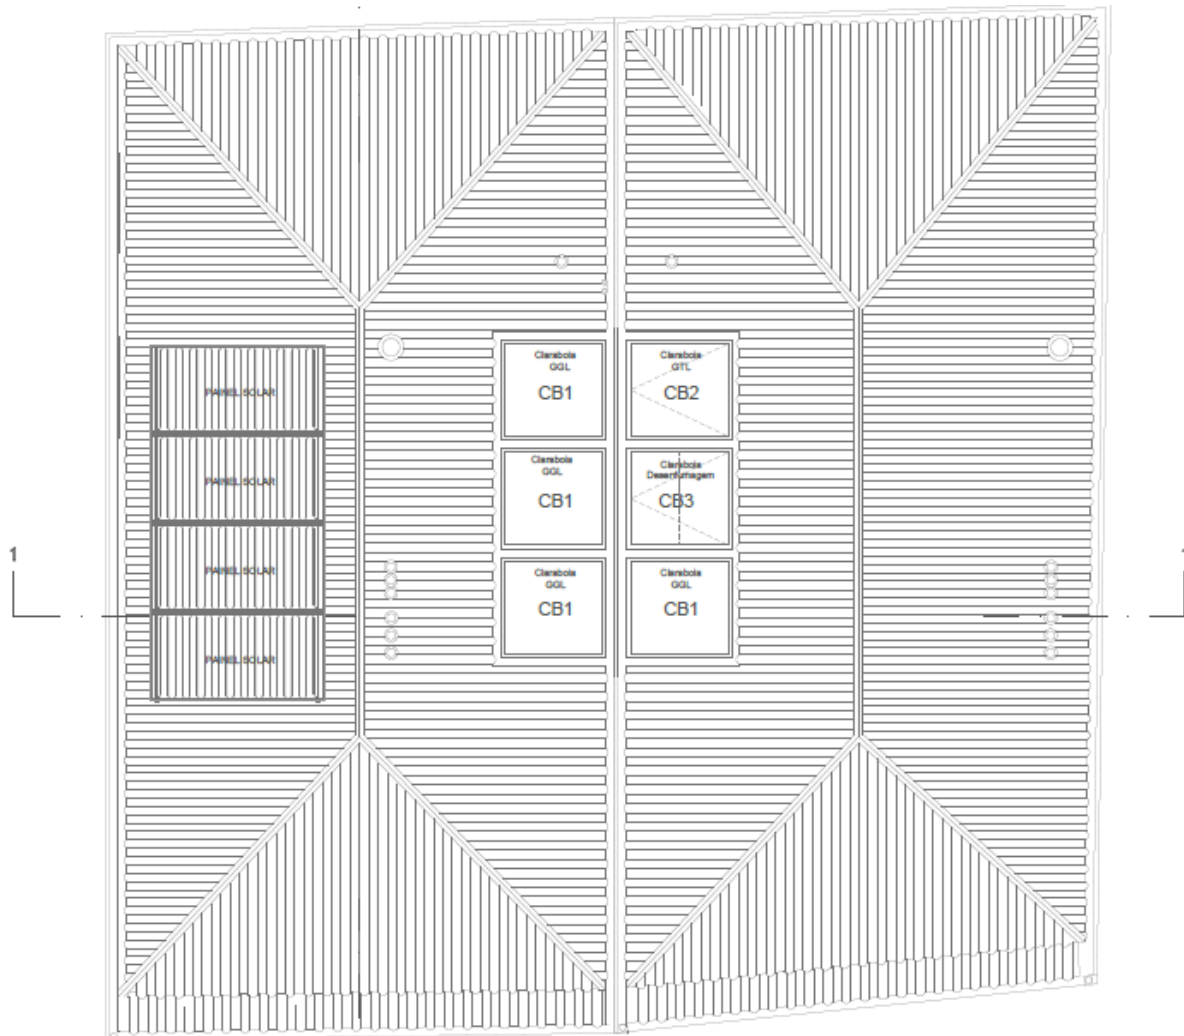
Planta da cobertura da Operação E2 (Fonte: Porto Vivo, SRU)
